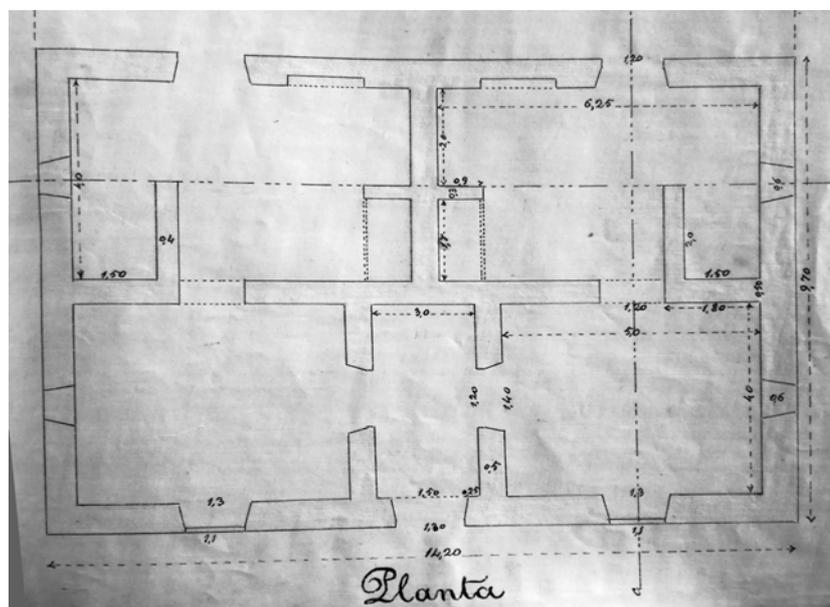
Planta da Casa dos Cantoneiros de Dogueno, in Arquivo Distrital de Faro
